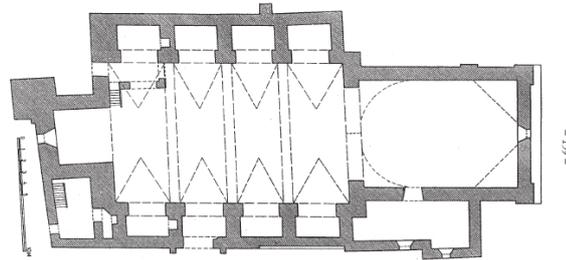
Planta de la iglesia de Santa María en Pozaldez (VA)
